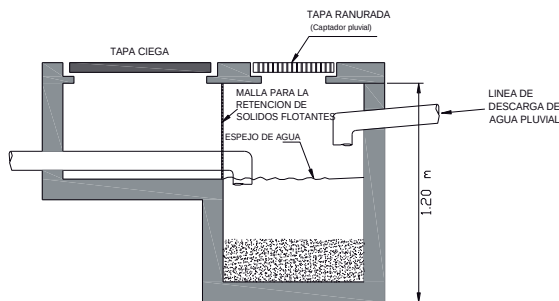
Detalle de registro arenoso para bajadas de aguas pluviales. Elaboración propia.
